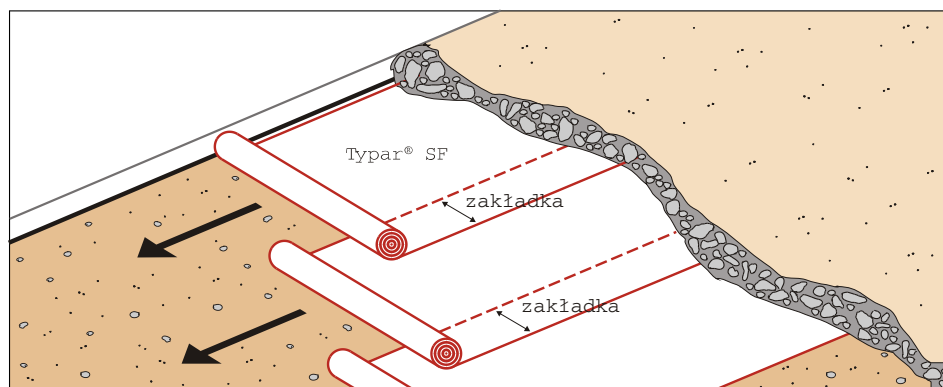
Zawinięcie kruszywa przez TYPAR® z zachowaniem minimalnego zakładu 30 cm
